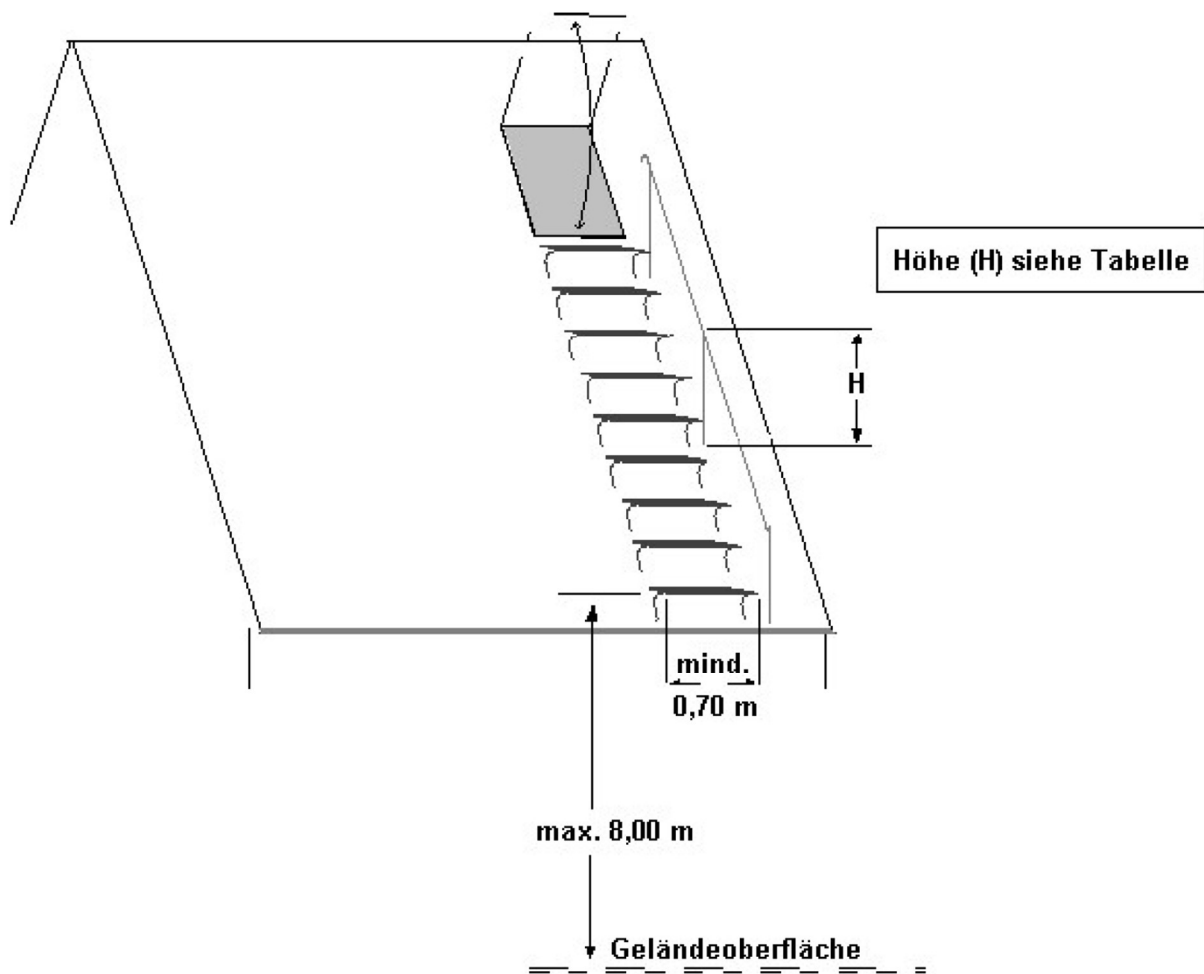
Ausführung von einzelnen Dachausstiegen
